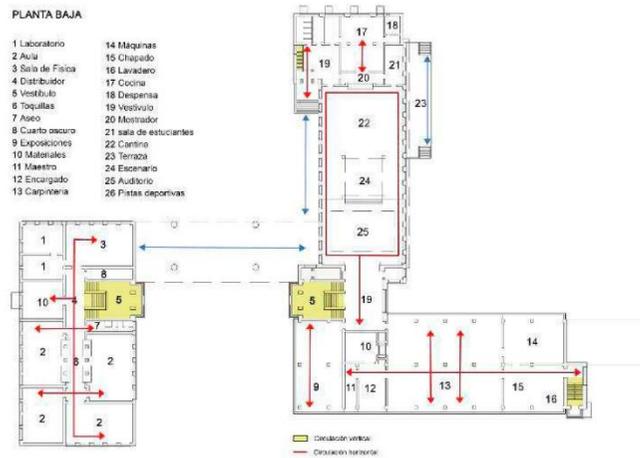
Planta Baja - Escuela de la Bauhaus
